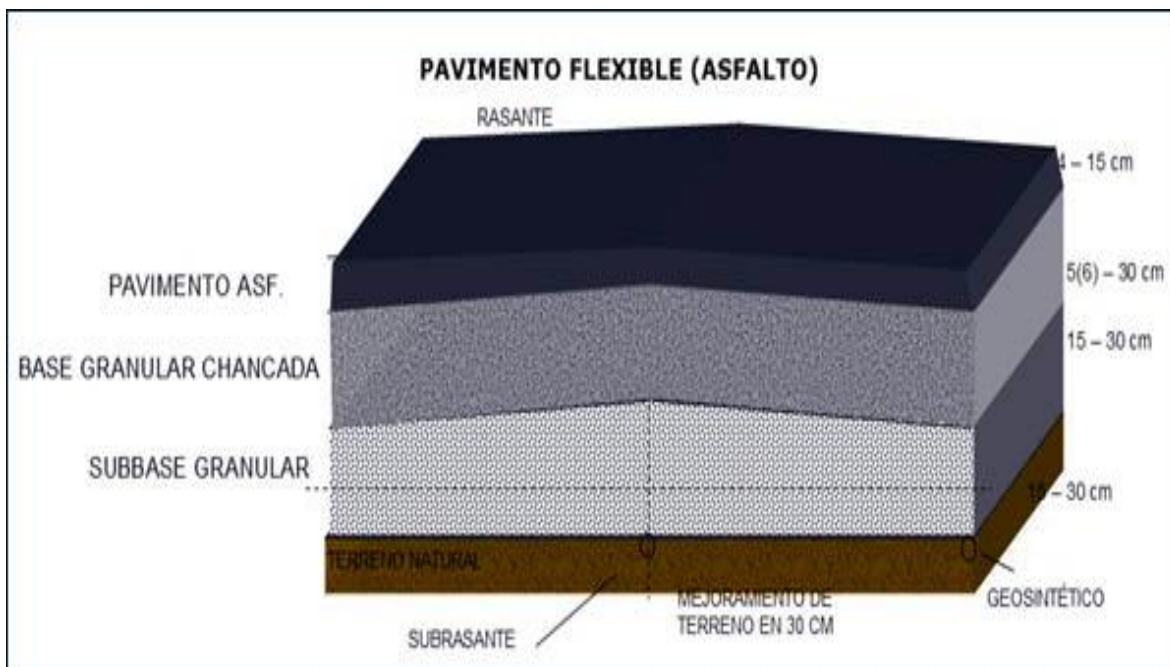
corte transversal del pavimento flexible (Génesis, 2005)
